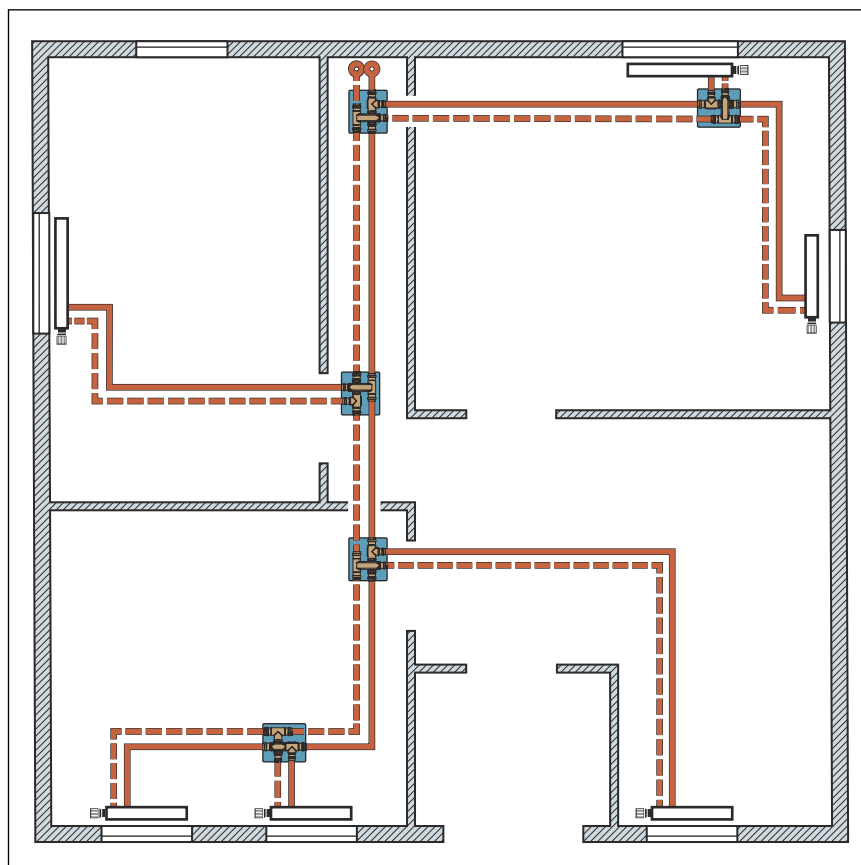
União de cruzamento em T Sanpress, exemplo de aplicação planta baixa
